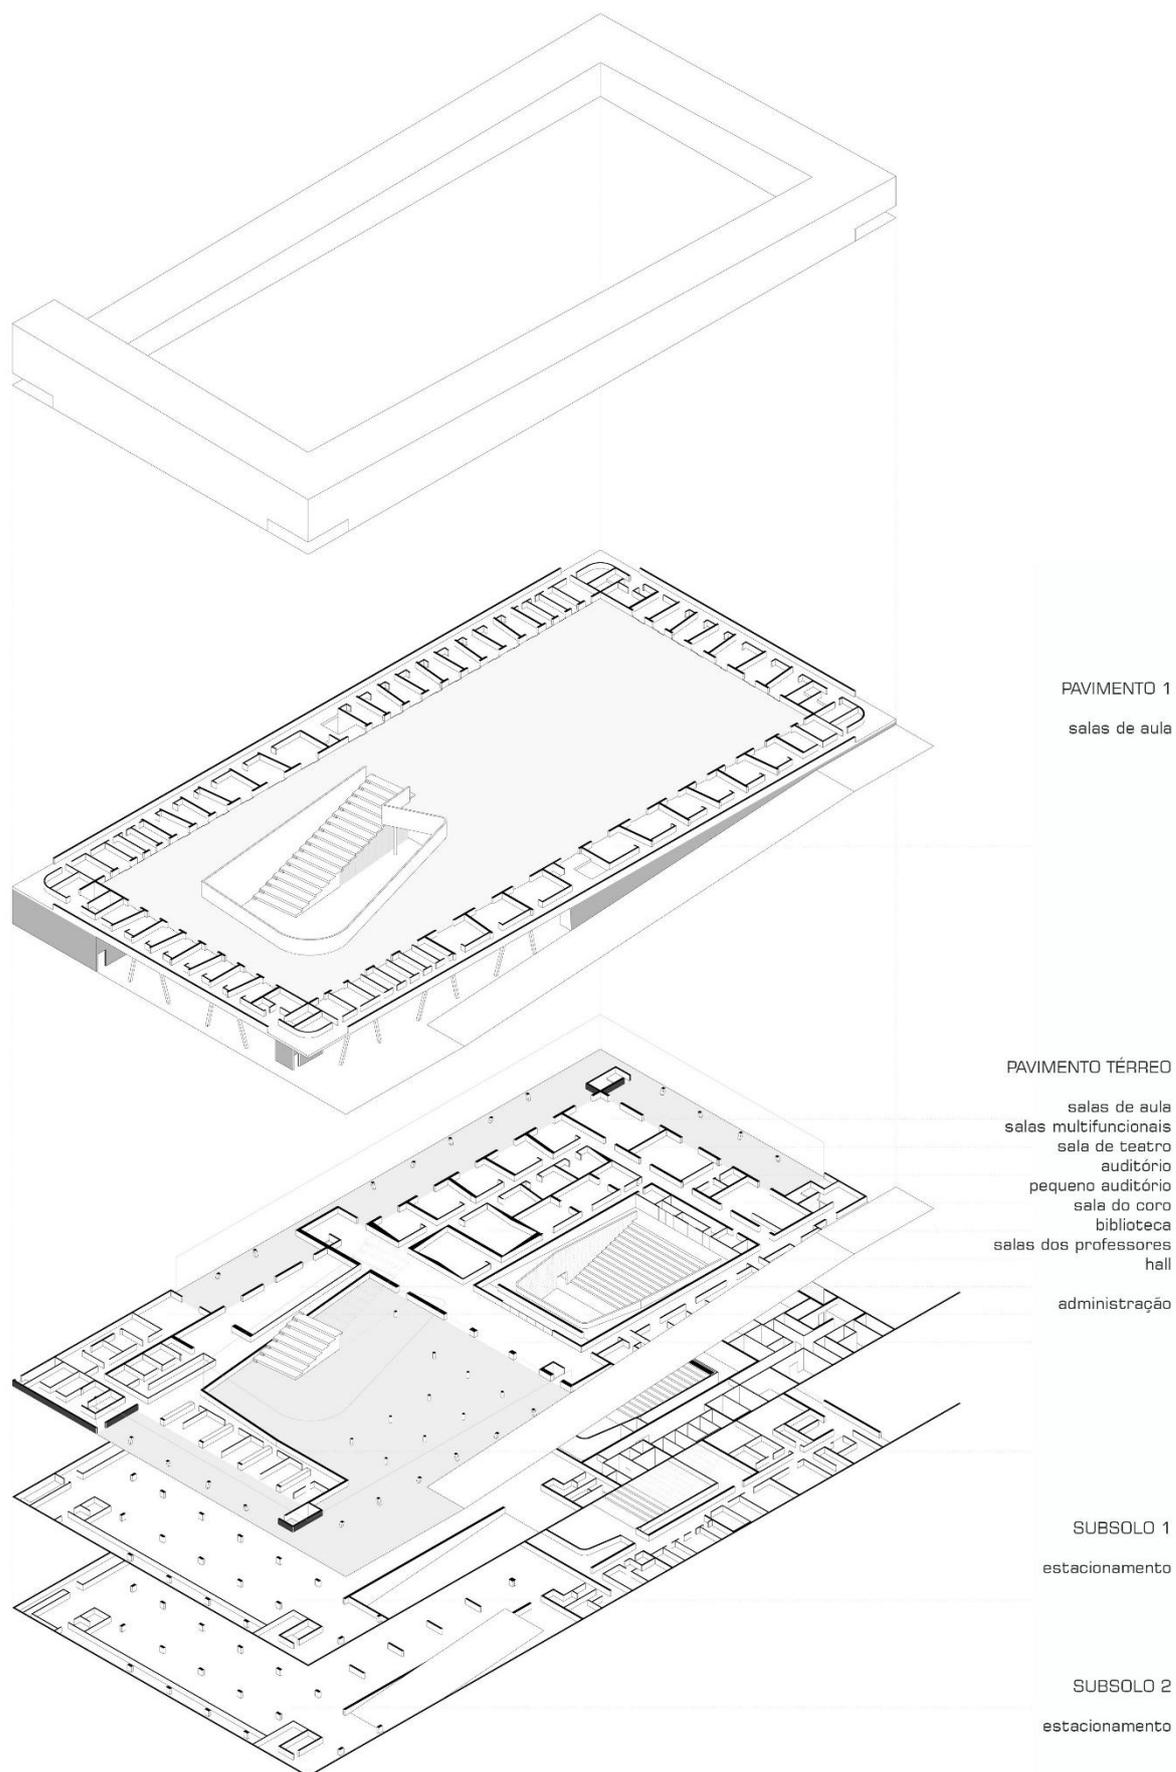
Distribuição programática nos pavimentos (FONTE: Open Buildings, 2013).
